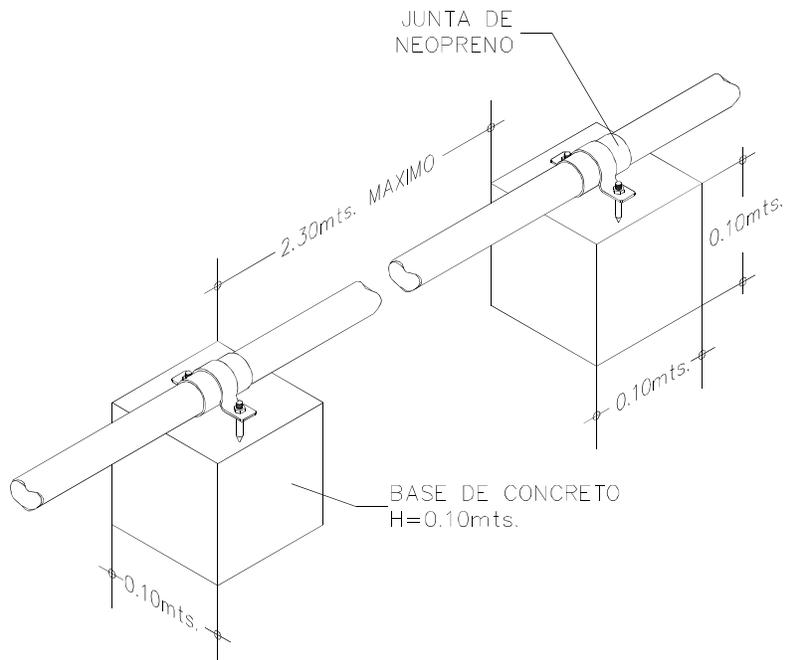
Tubería sujeta sobre base de concreto que se instalará en la azotea para distribuir el gas LP a los puntos de consumo.
